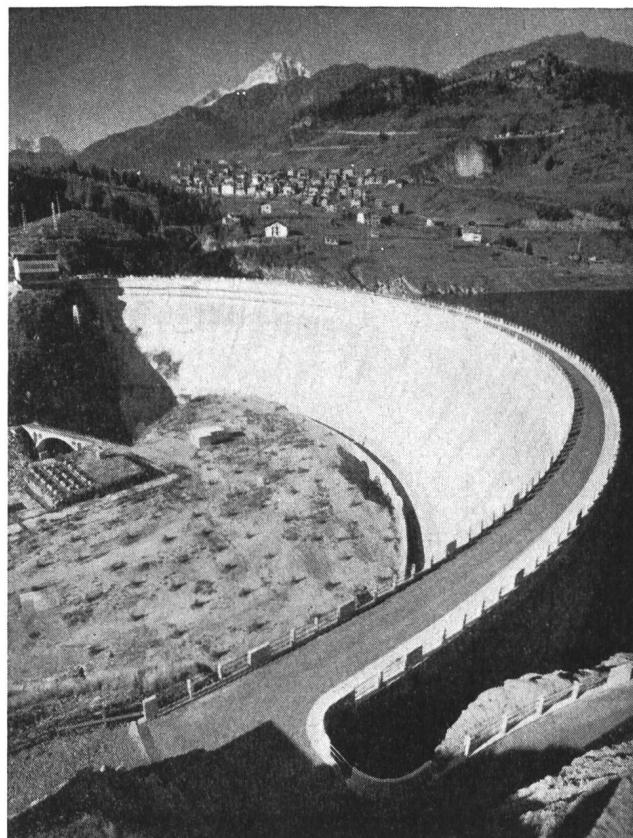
Staumauer Pieve di Cadore, mit Blick auf das Städtchen Pieve di Cadore. (Photo Ferruzzi, Venezia / SADE)
